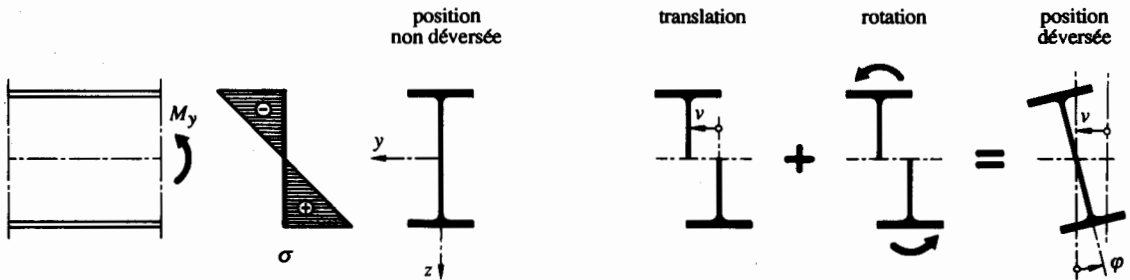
Translation et rotation d'une section d'un élément de poutre sujet au déversement.
